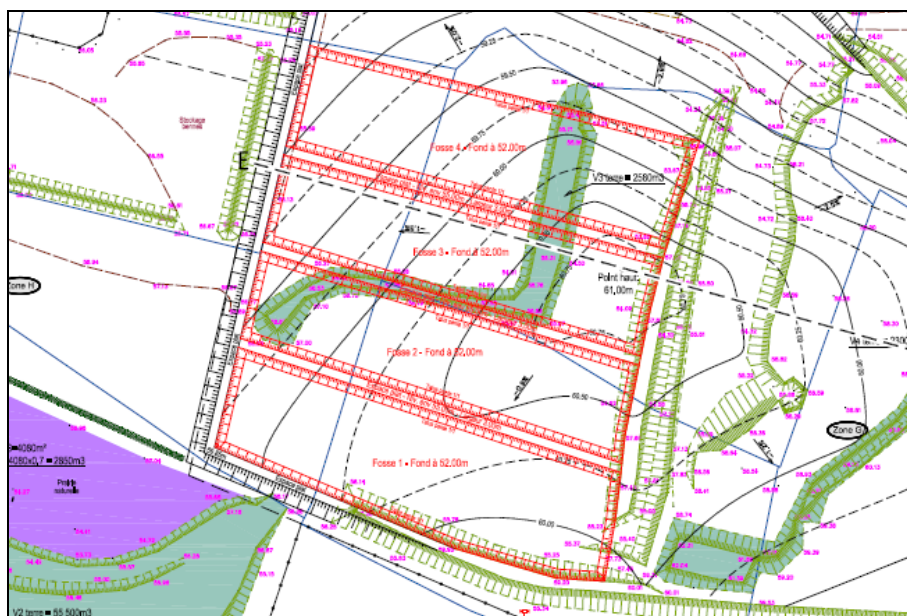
PLAN DES FUTURES ALVÉOLES DE STOCKAGE
